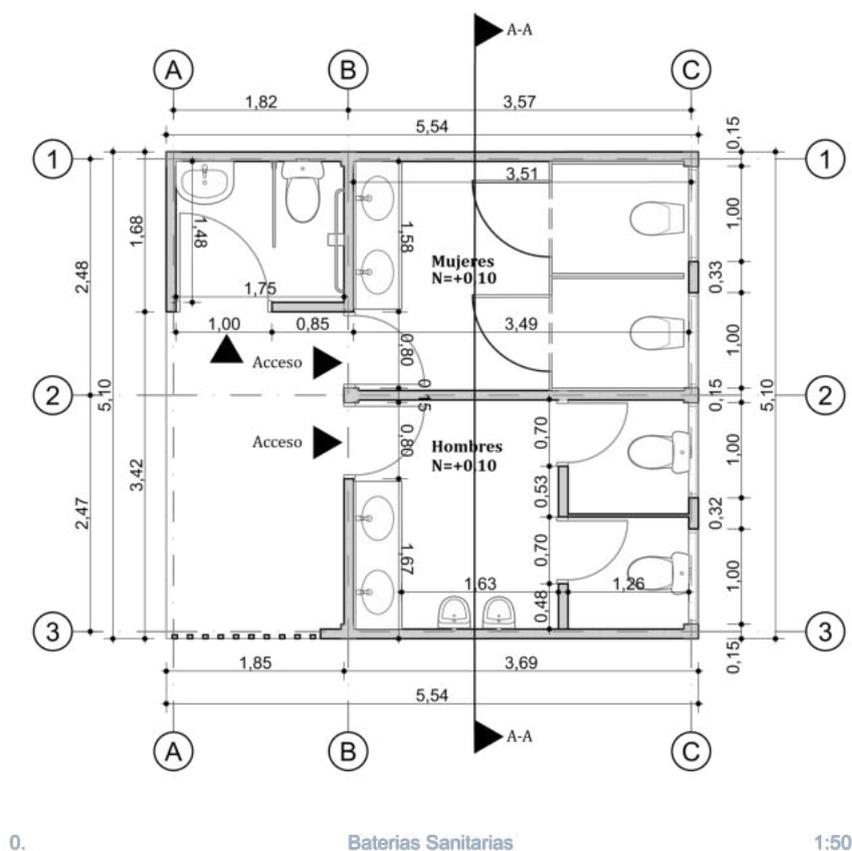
Plano 2-Planta arquitectónica de baterías sanitarias. Fuente: Elaboración propia
